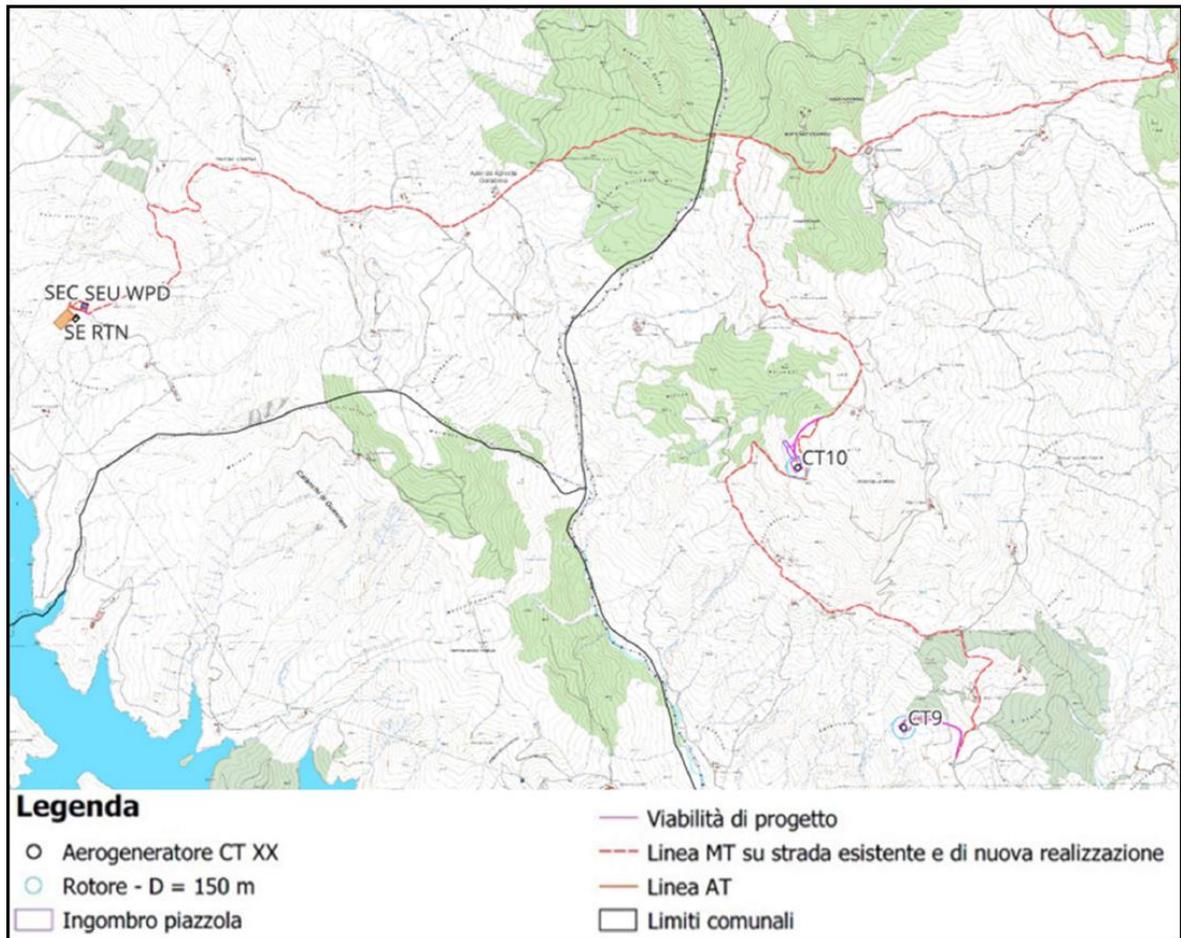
Layout d'impianto relativo alla zona 1 su CTR
